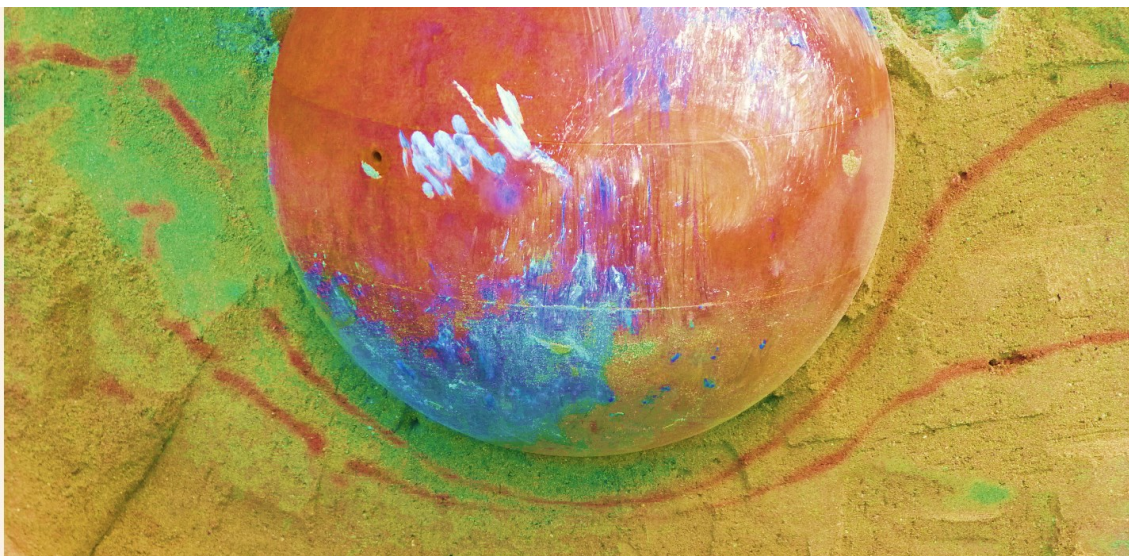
Déplacements après impact dans la couche de sable – Essais préliminaires, remblai B
